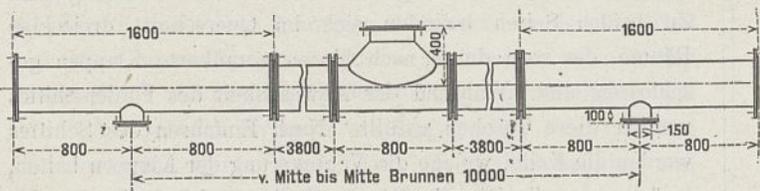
Ohne Schieber und mit Pumpenanschluß.
